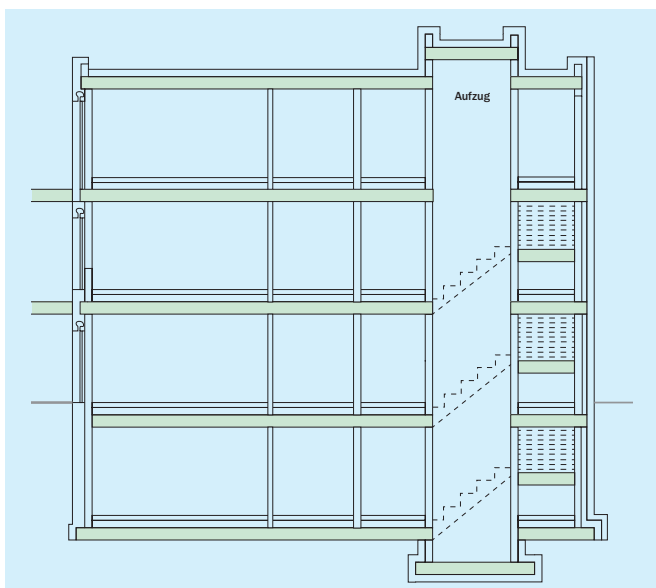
Einheitlicher Lastabtrag durch gleiche Grundrissgestaltung
